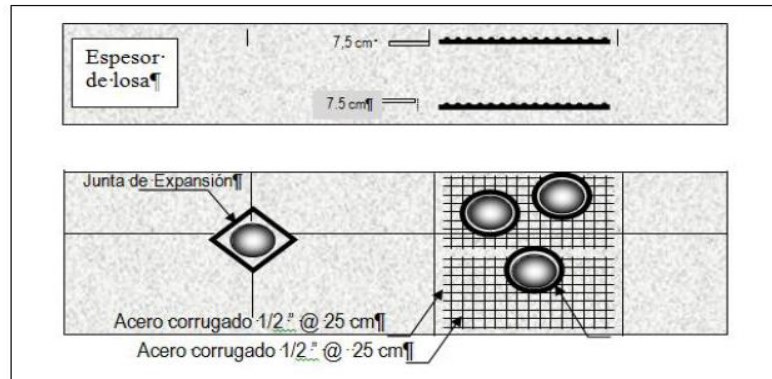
Detalles del reforzamiento de losas con dos parrillas de acero
